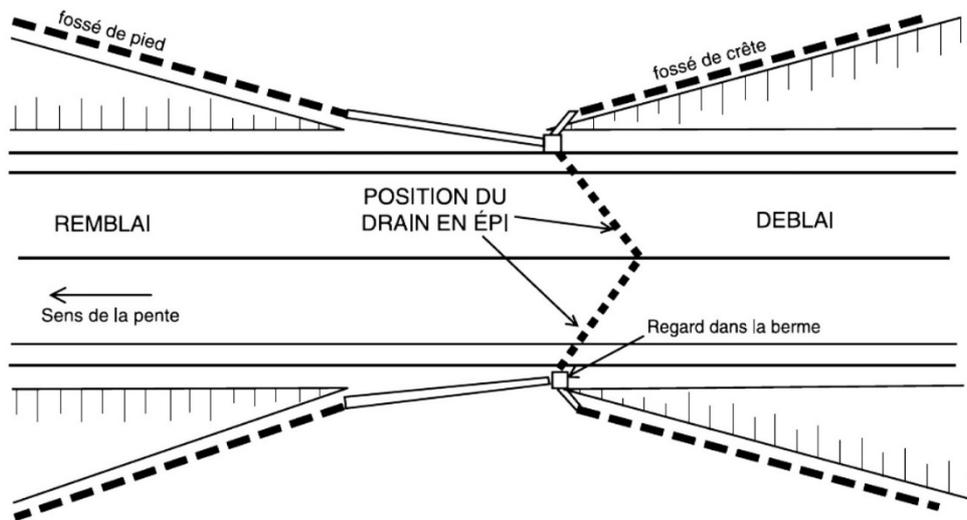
Ejemplo de planta de drenaje en una transición desmonte-terraplén (Setra 2006, Esquema 14)
